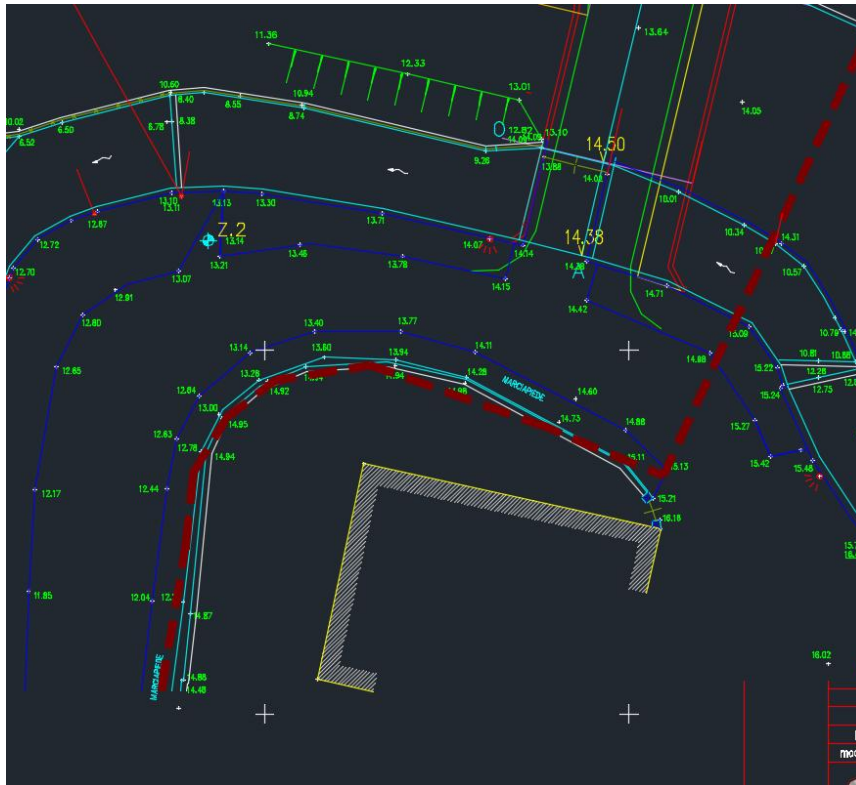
intersezione nuovo ramo con via dell'Acciaio
